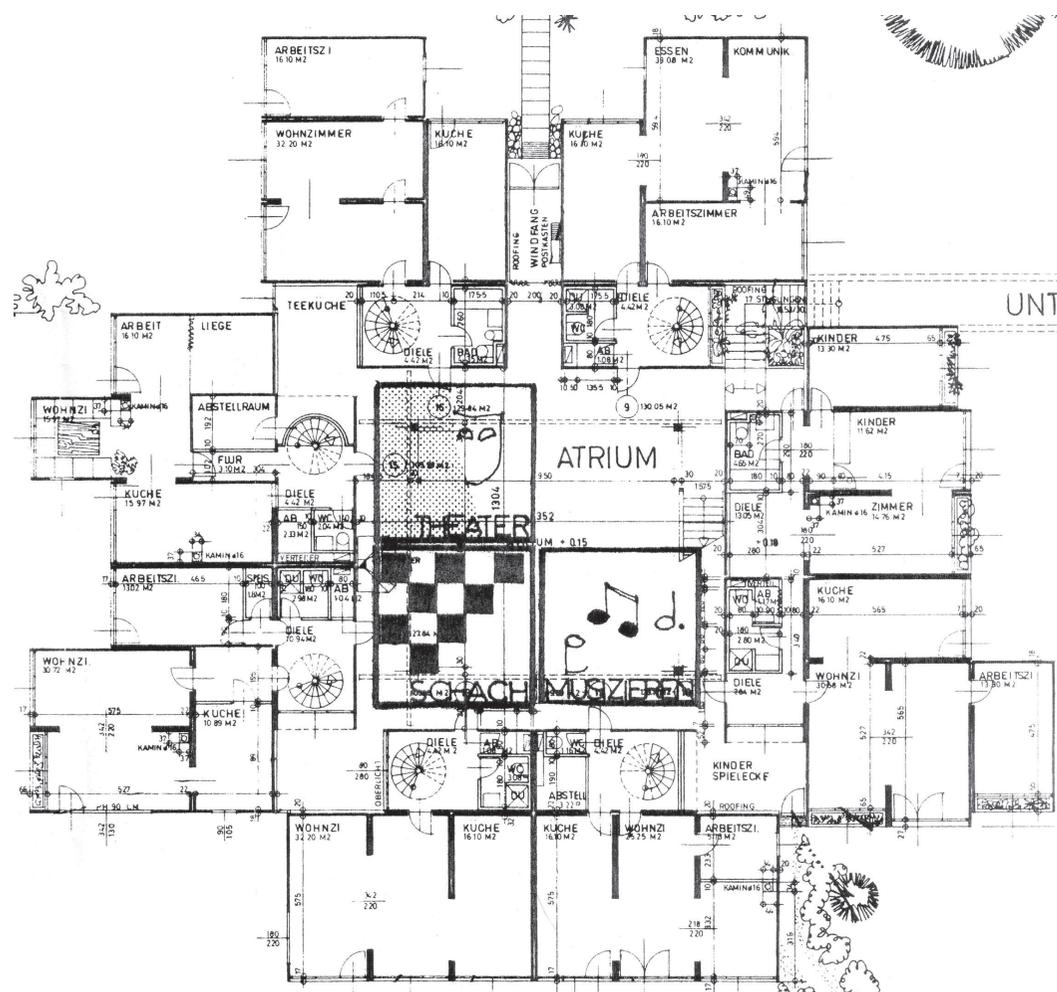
Grundriss Westhaus, Anlage Bürooos
